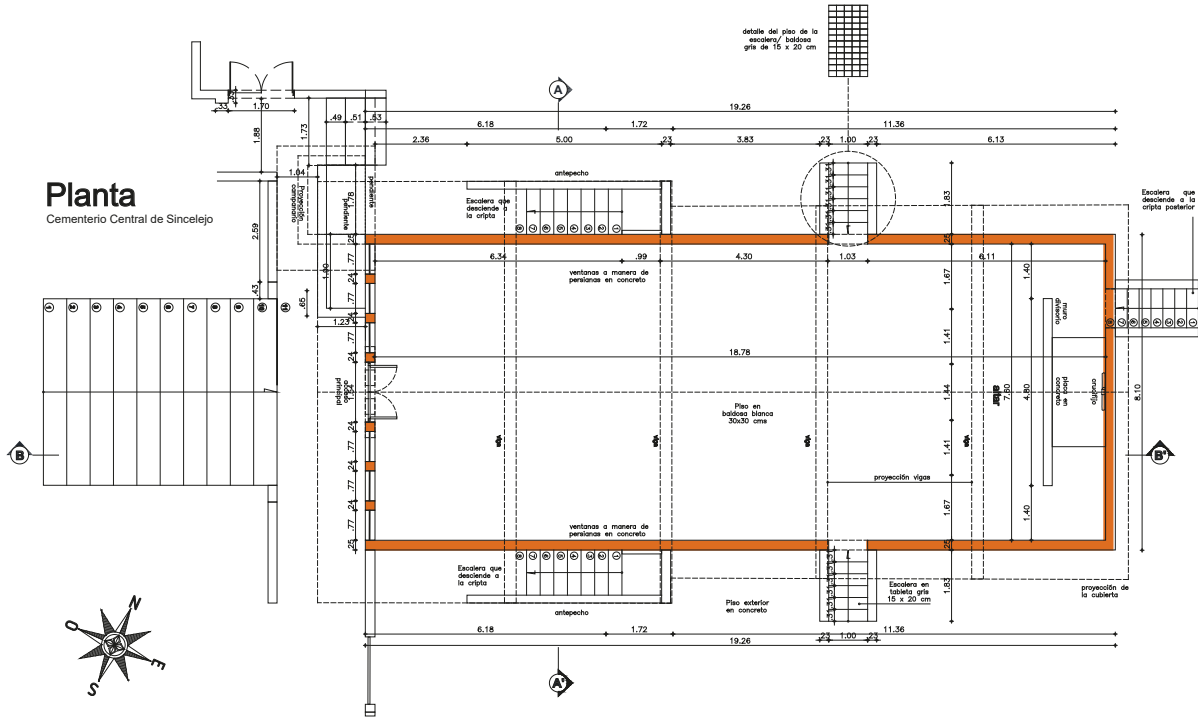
Planta primer piso Capilla Cementerio Central de Sincelejo.
